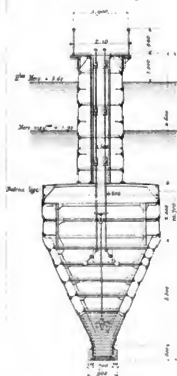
Ech. 1/200 Coupe longitudinale sur
